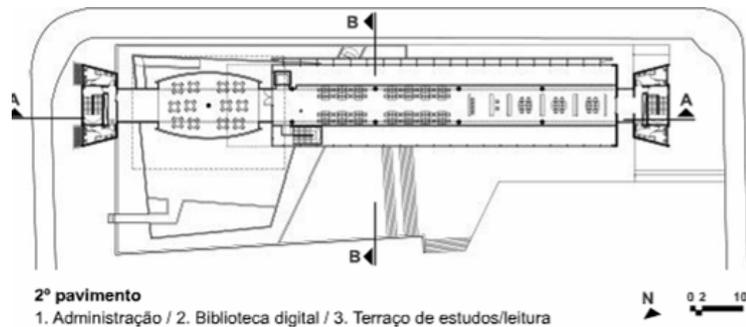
Plantas baixa segundo pavimento (MELENDEZ, 2008)
